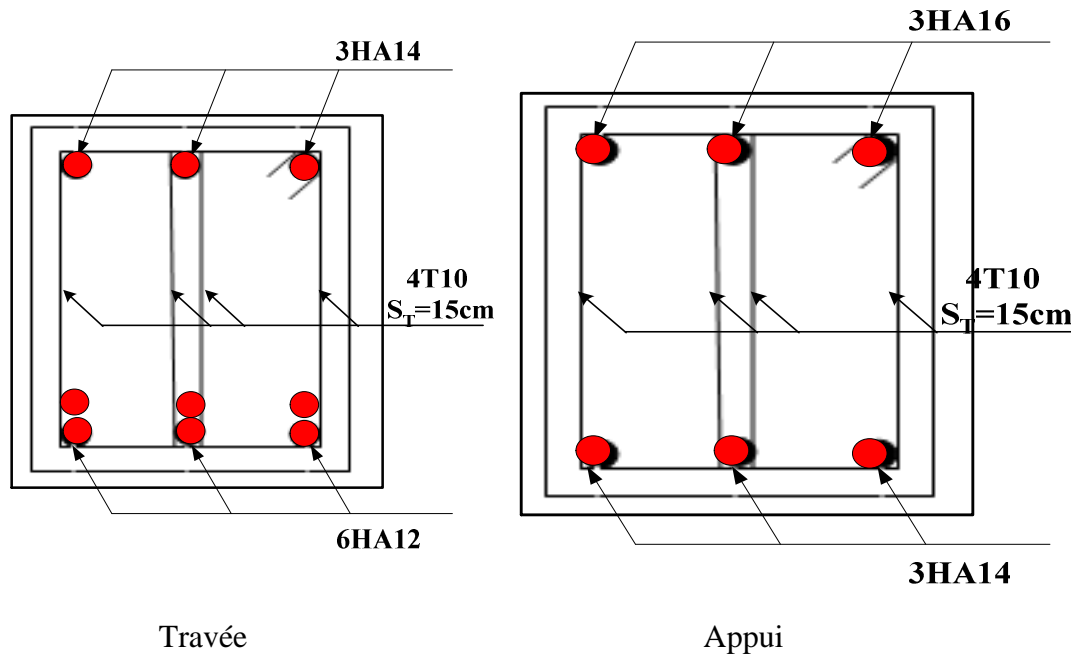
Schéma de ferrailage des poutres secondaires de la terrasse
